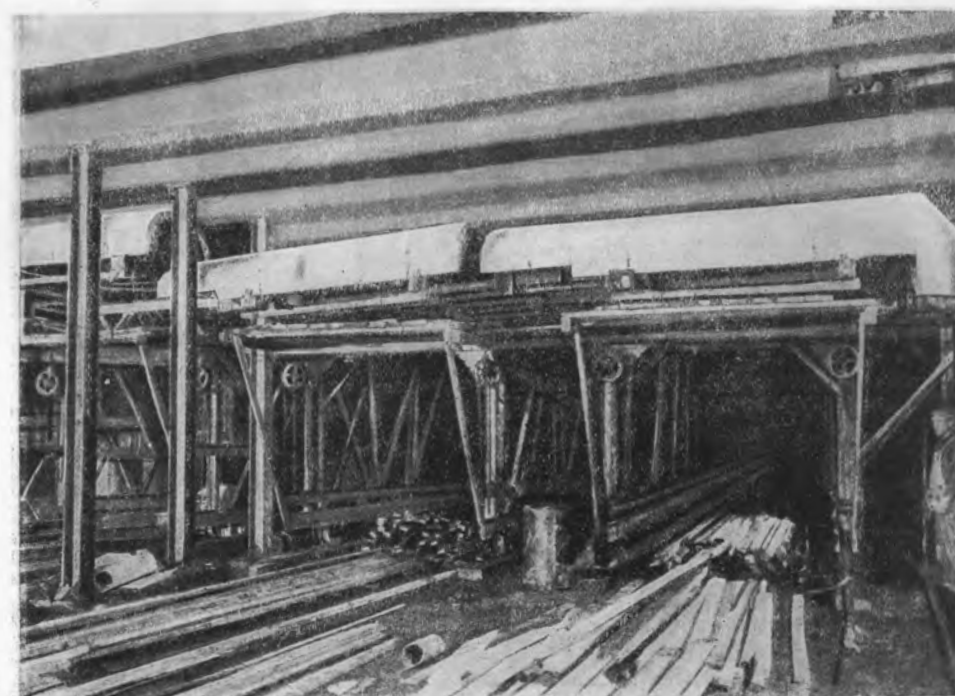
Подвижная металлическая опалубка несущих плоских перекрытий тоннелей метрополитена.
